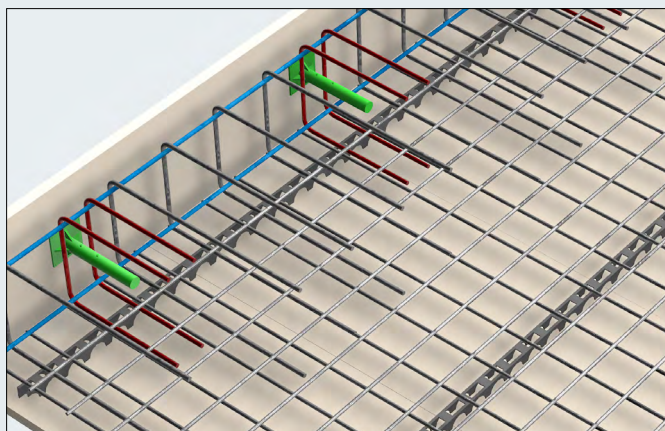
Anordnung der Querkraftdornhülsen, untere Bewehrungslage verlegen und Zulagebewehrung anordnen (Abstände beachten).
